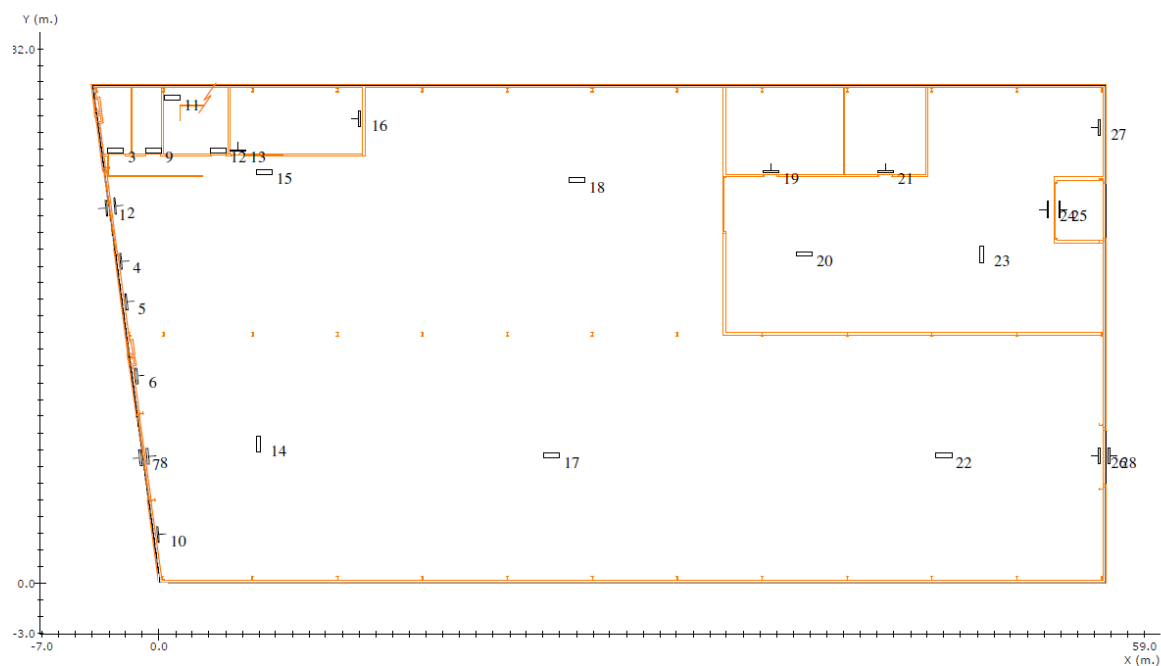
Situación de las luminarias de emergencia (Planta baja).
